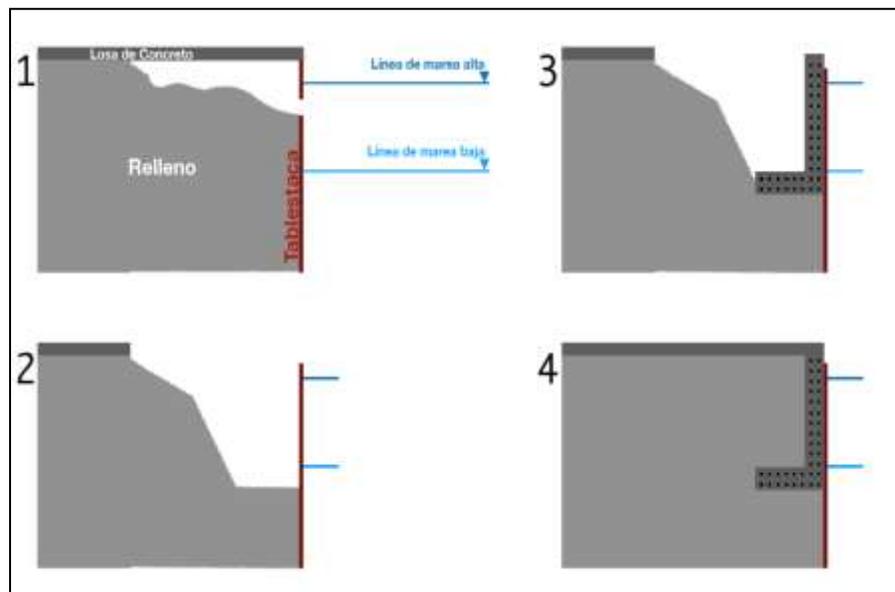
Ilustración gráfica de pasos a seguir para la construcción de un muro de concreto reforzado.
